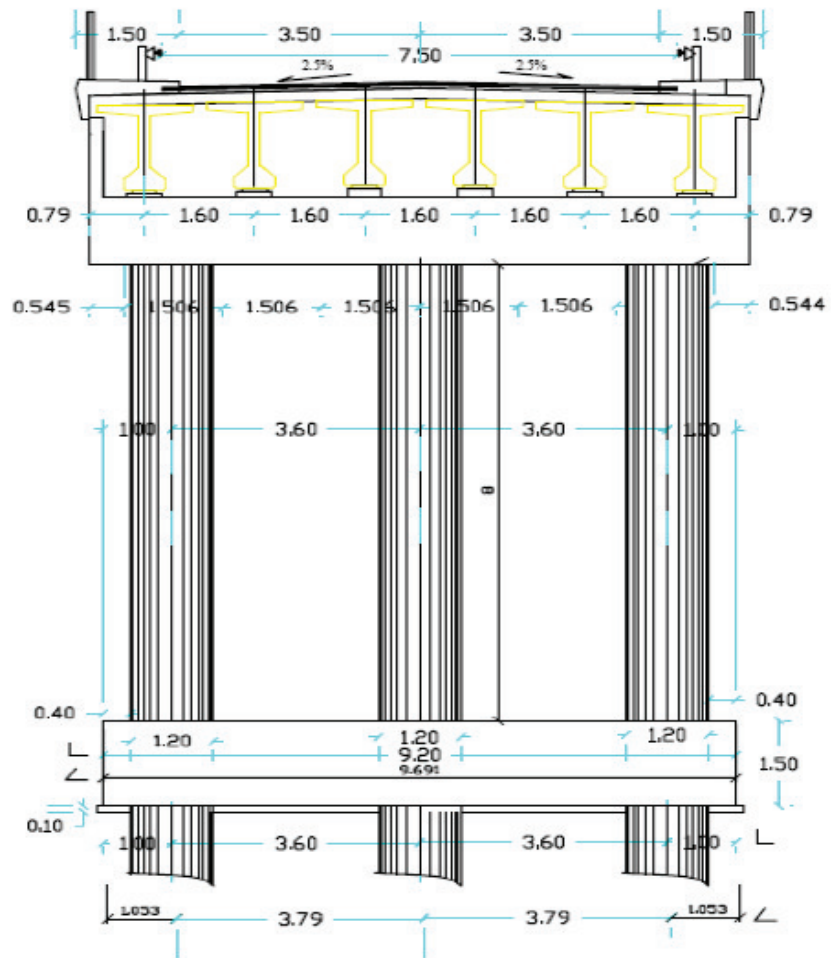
Coupe transversale de la pile (hauteur 8m).
